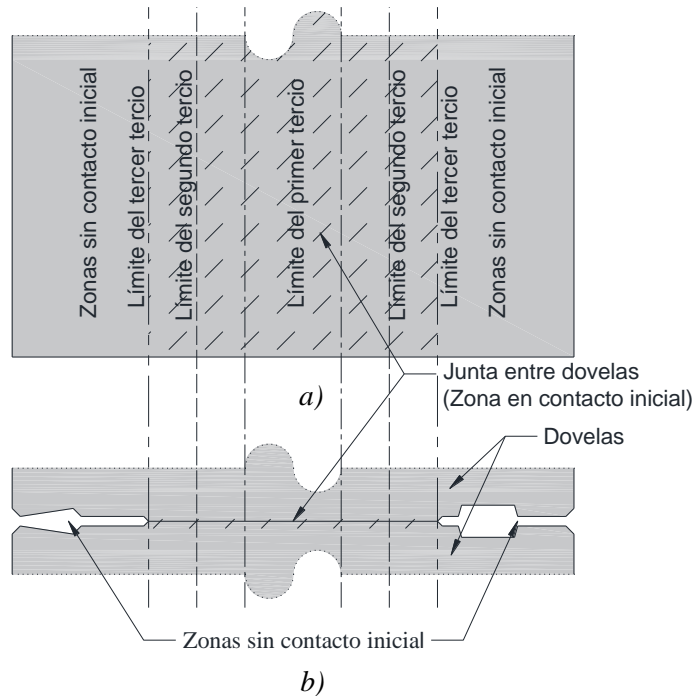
Detalle tipo de las juntas ensayadas: a) vista en planta; b) vista frontal.
